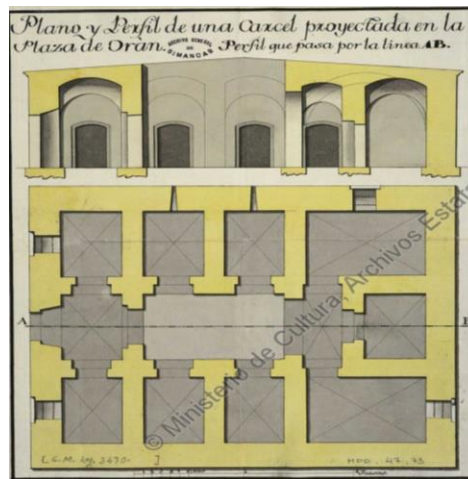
Plano y Perfil de una cárcel proyectada en la plaza de Orán.
